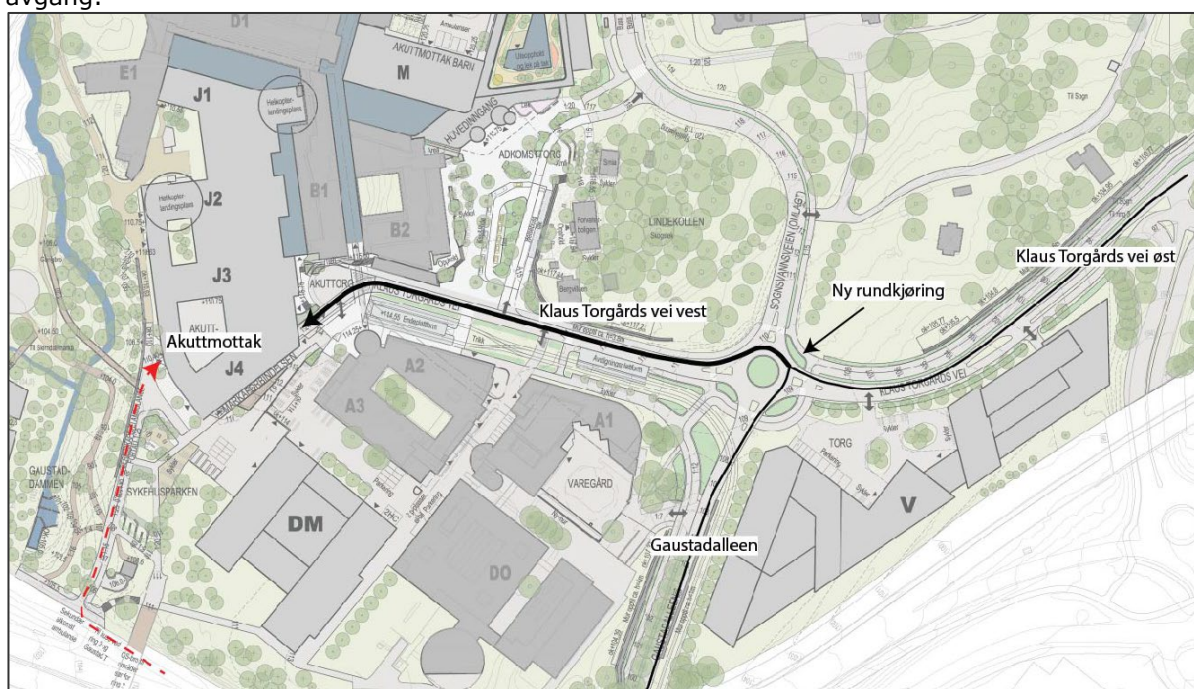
Situasjonsplan. Planalternativ 2A og 2B.
